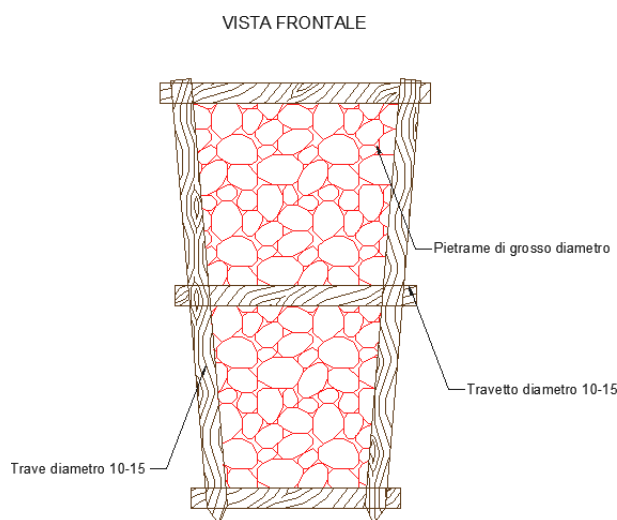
Sezione tipo di canalizzazione in legname e pietrame
